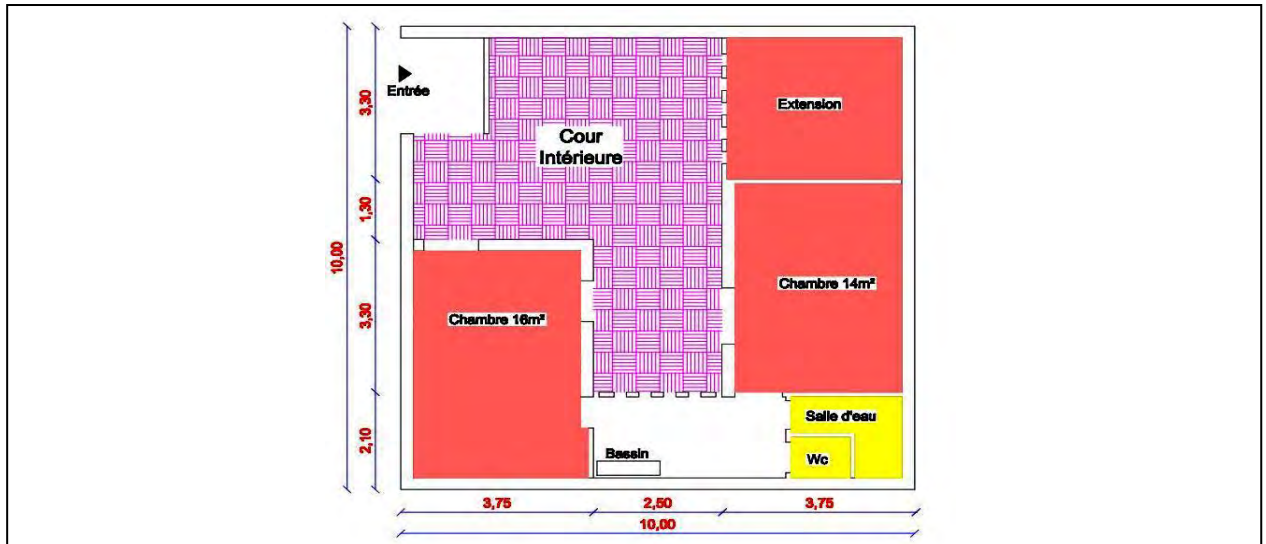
Plan de cellule Type (200 logements), Plan de masse & RDC.
